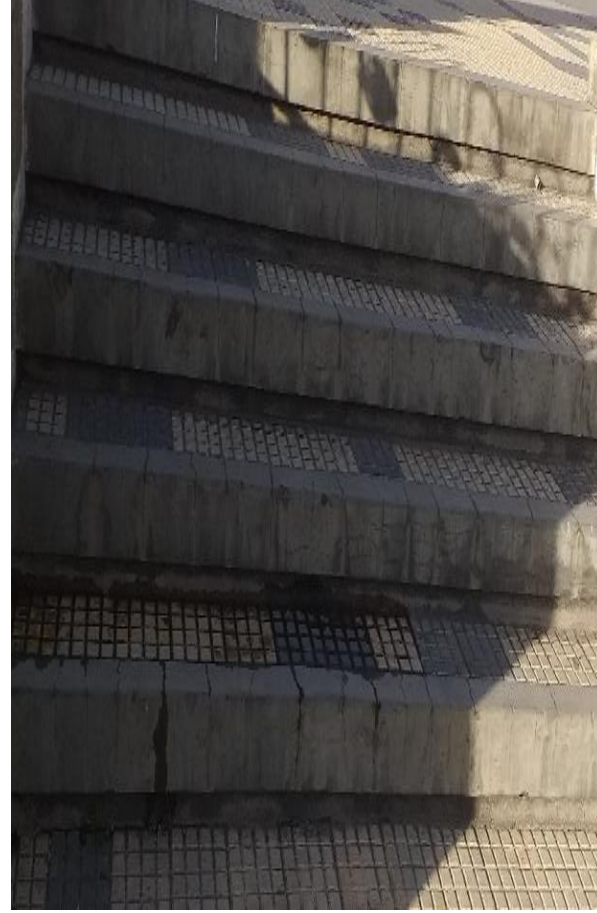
Escalera ubicada en la plaza de armas, afectada por grietas.
